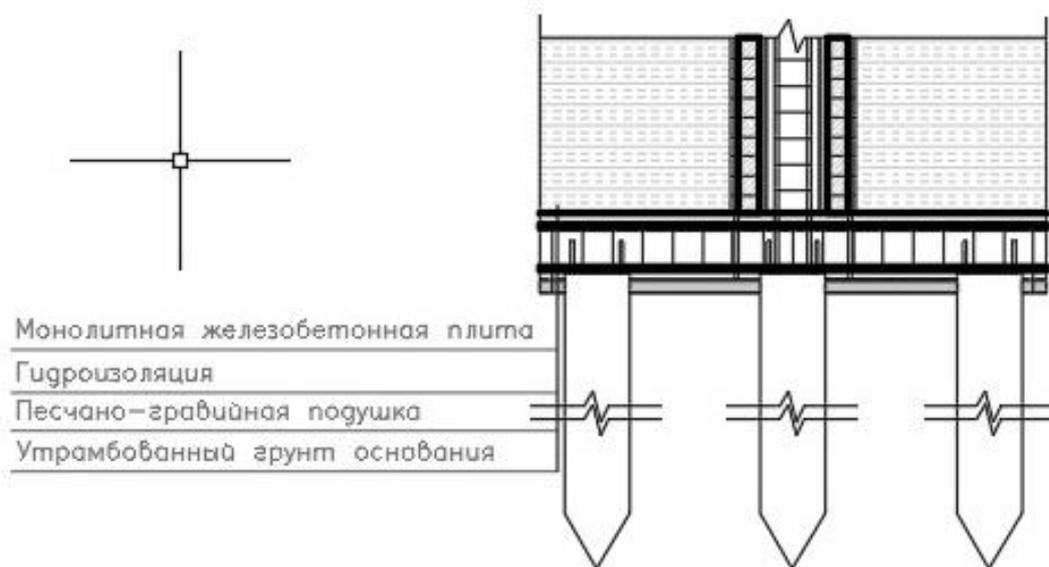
Узел свайного фундамента и железобетонной колонны
